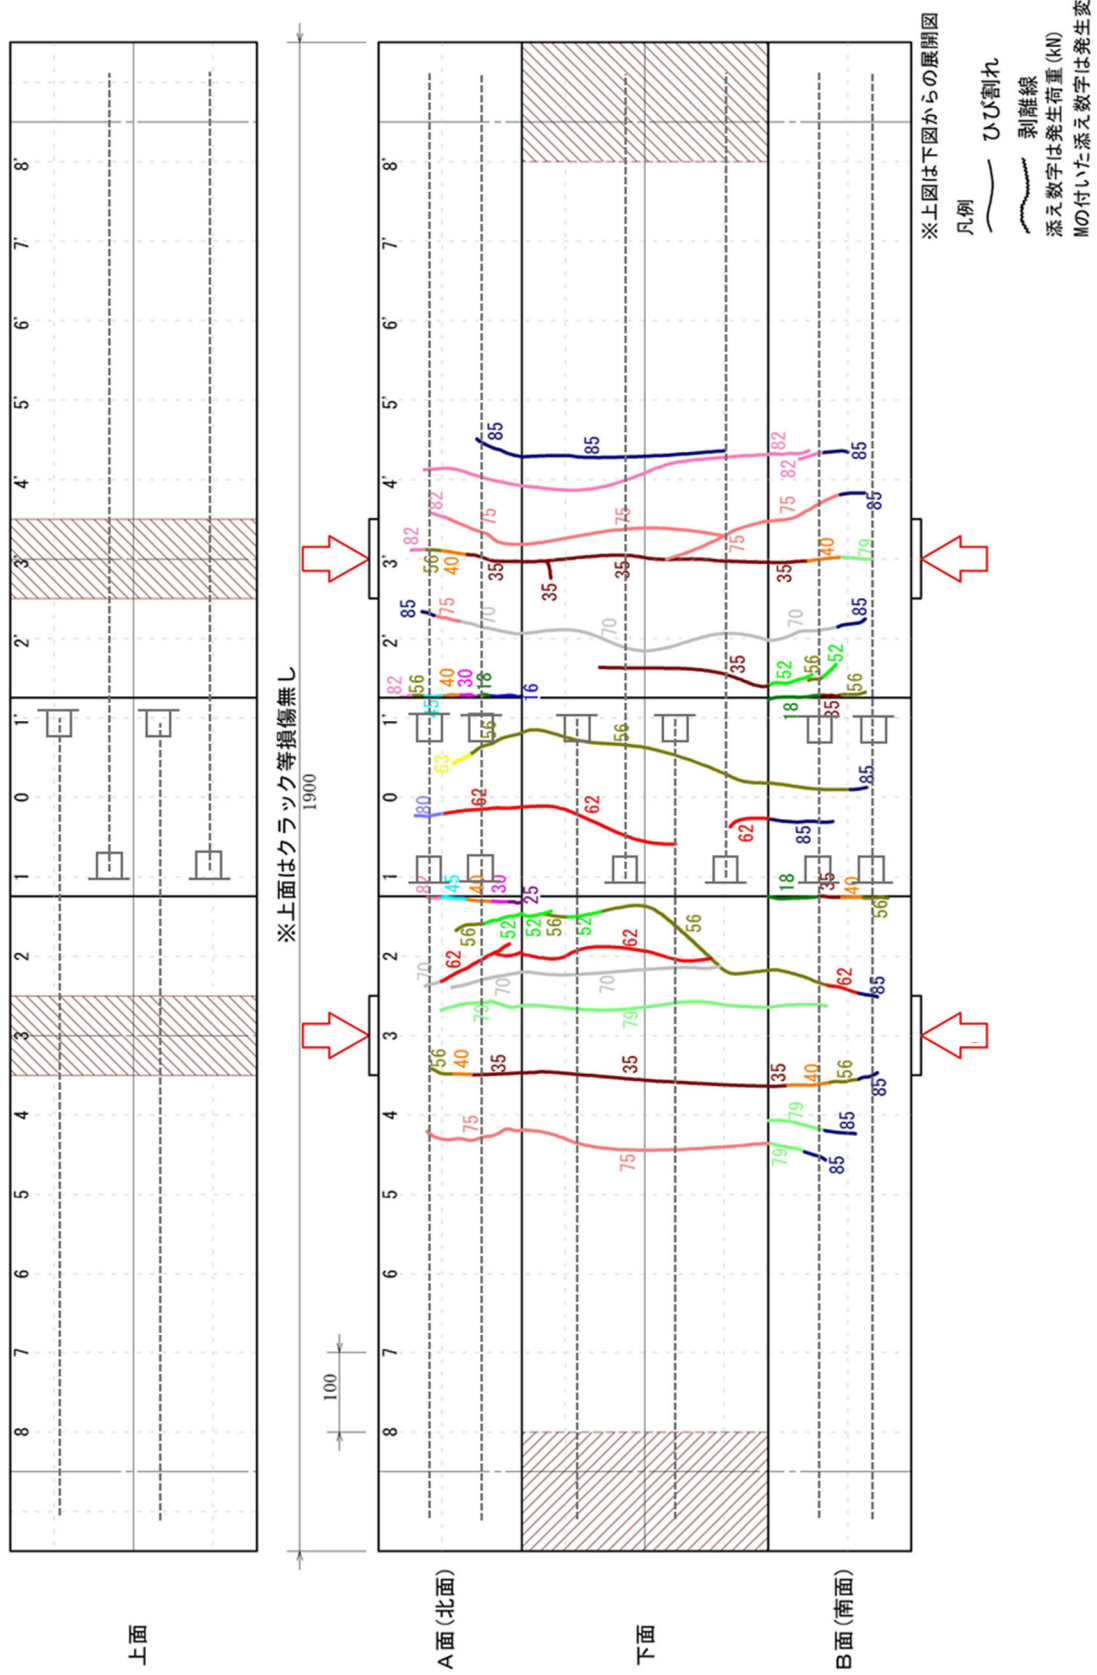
ひび割れ図 (供試体 S1-1)
